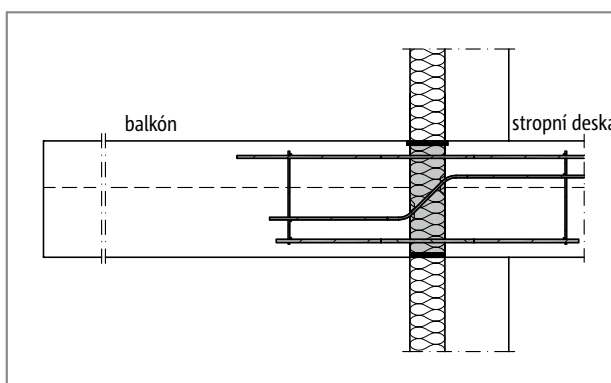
Schöck Isokorb® XT typ BP: Balkónová konstrukce s volně vyloženými průvlaky (prefabrikovaný balkón)
